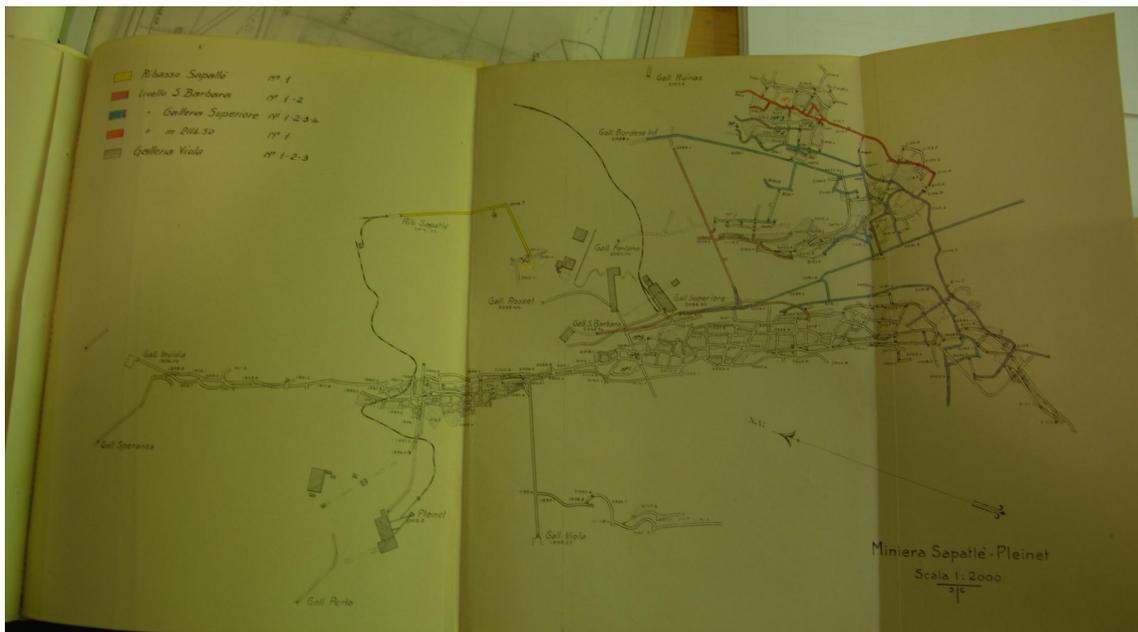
Planimetria “Miniera di Sapatlè-Pleinet”-scala originaria 1:2000⁶¹
